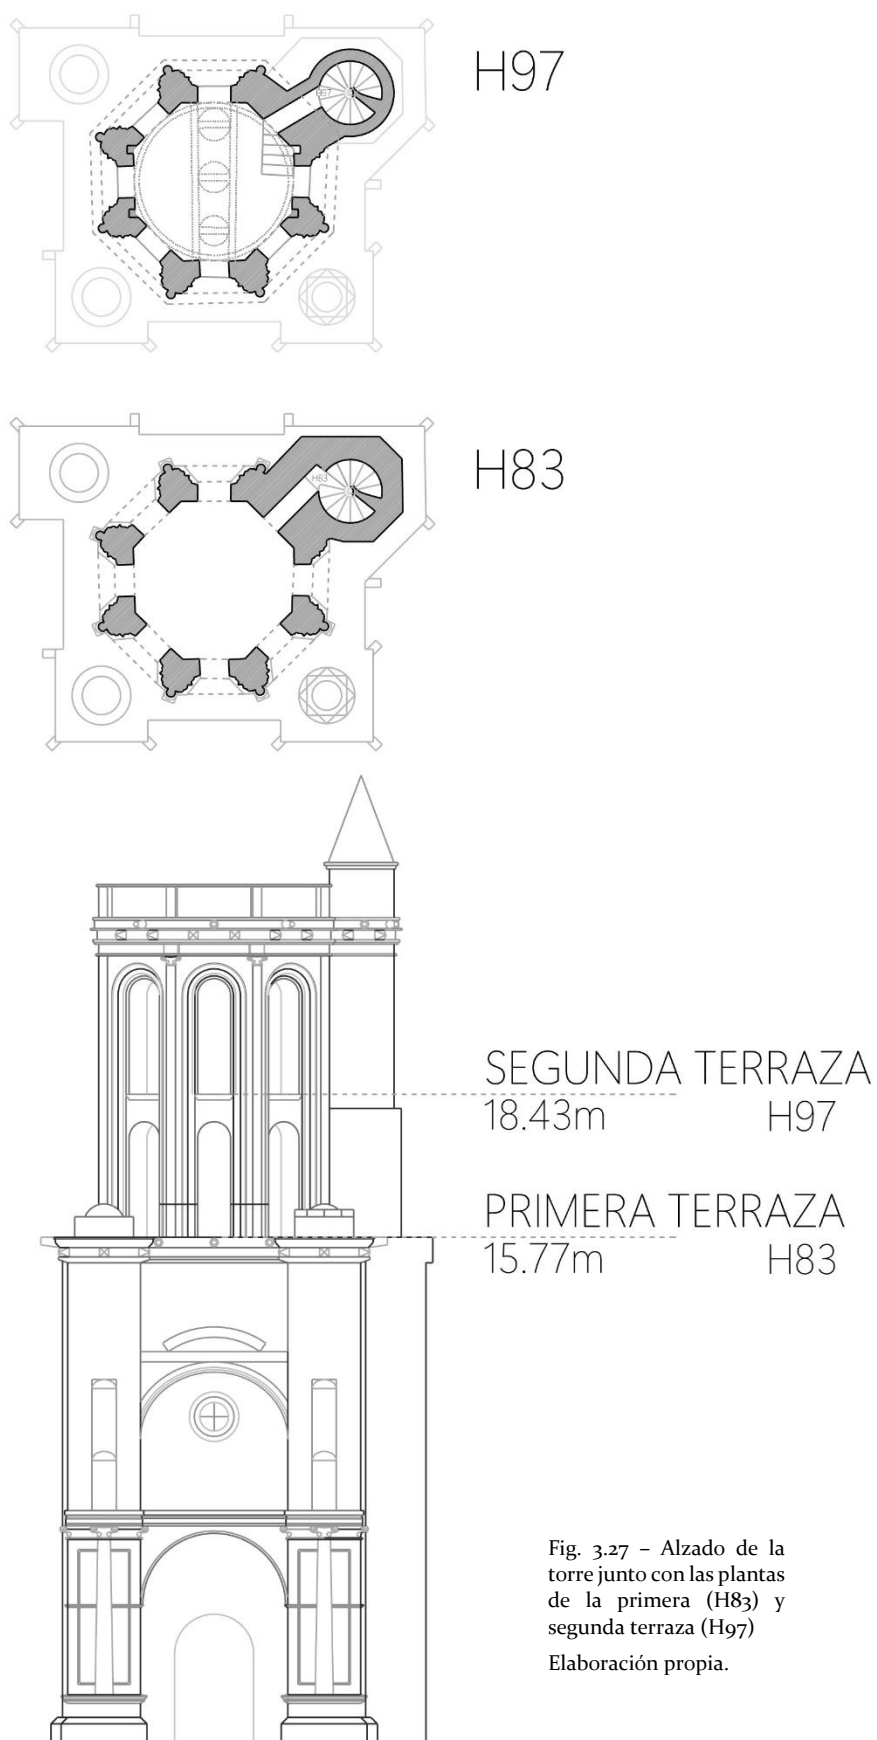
Alzado de la torre junto con las plantas de la primera (H83) y segunda terraza (H97)
